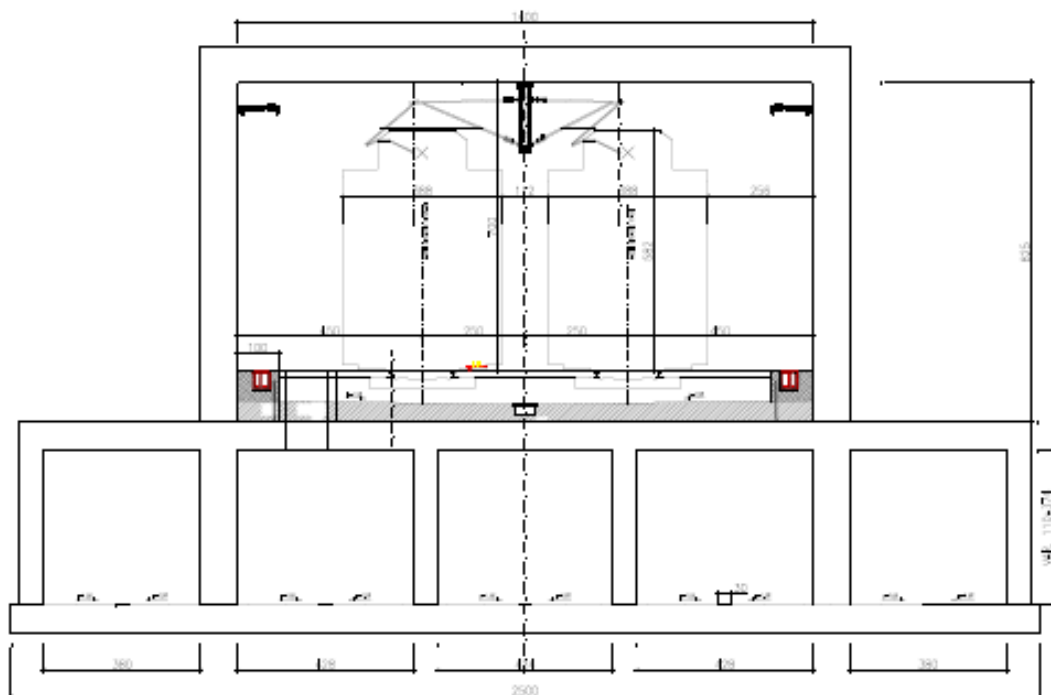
Sezione tipo galleria Fontanellato “con cassoni”
